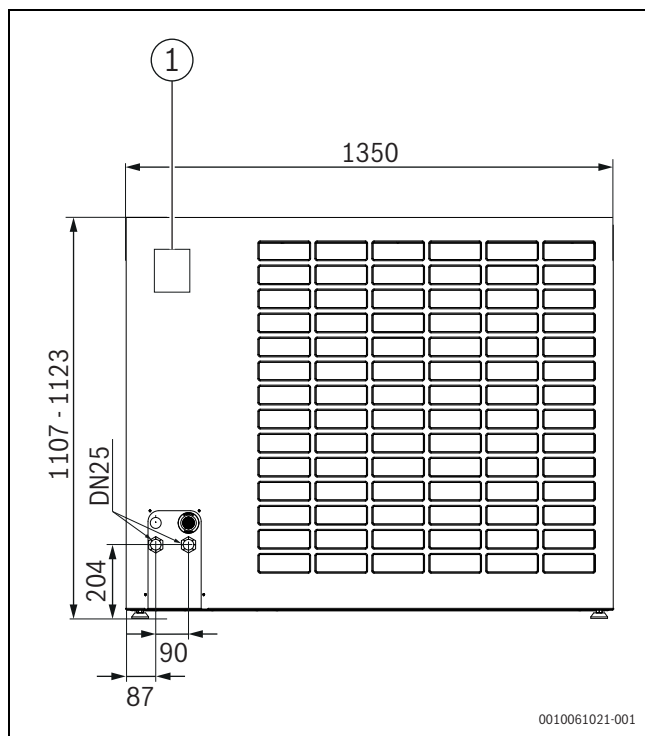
Dimensions et raccordements de la pompe à chaleur, arrière
